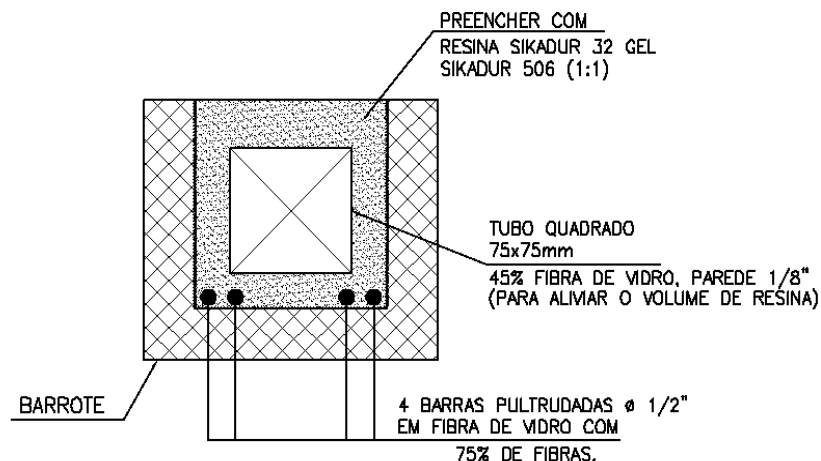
Corte esquemático do sistema de reforço do barroteamento de piso, com a utilização de barras pultrudadas de fibra de vidro, do Museu Nacional da Quinta, na Quinta da Boa Vista.
